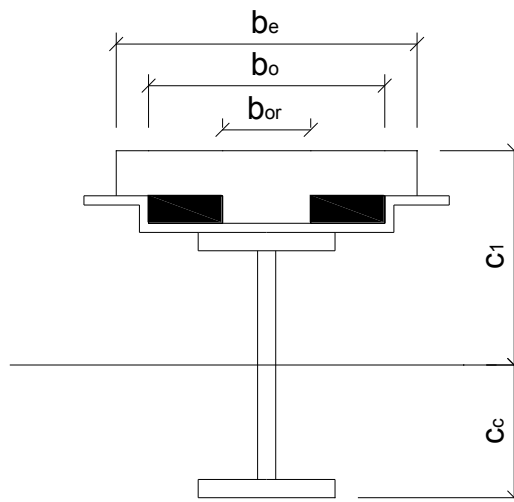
Sección compuesta homogeneizada. Nervaduras paralelas. Eje neutro fuera de la sección de hormigón.
